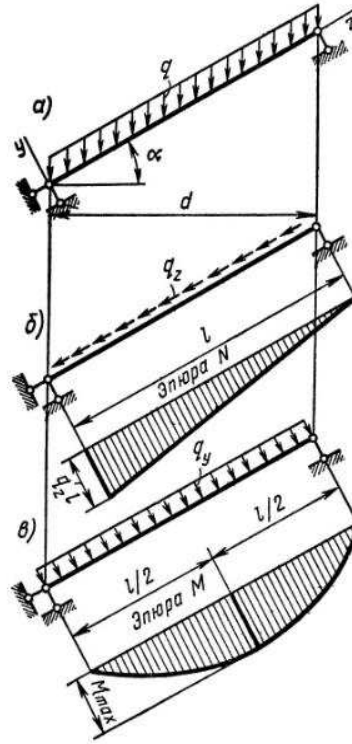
а) Расчетная схема косоура; б) Эпюра от продольной силы; в) Эпюра моментов
